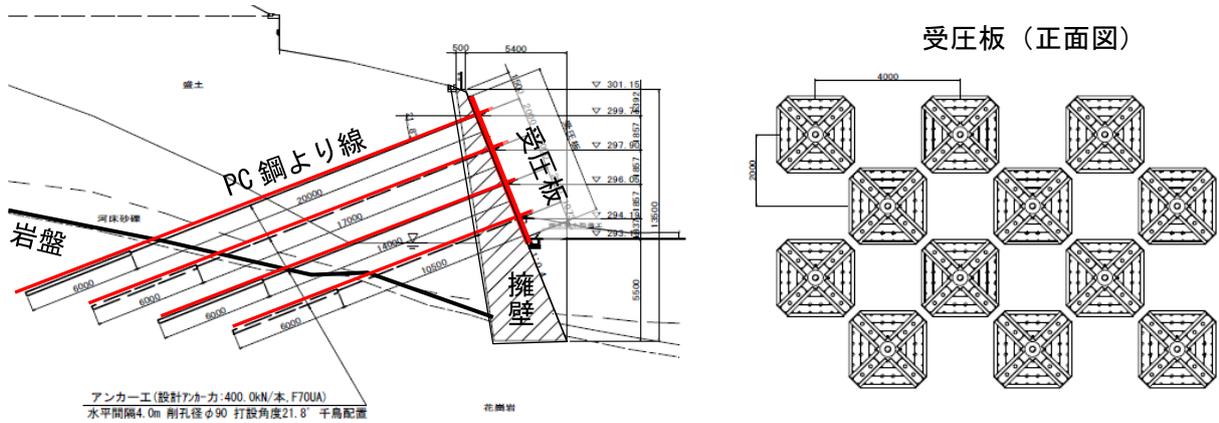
アンカーの概要 (左：断面図、右：正面図)
